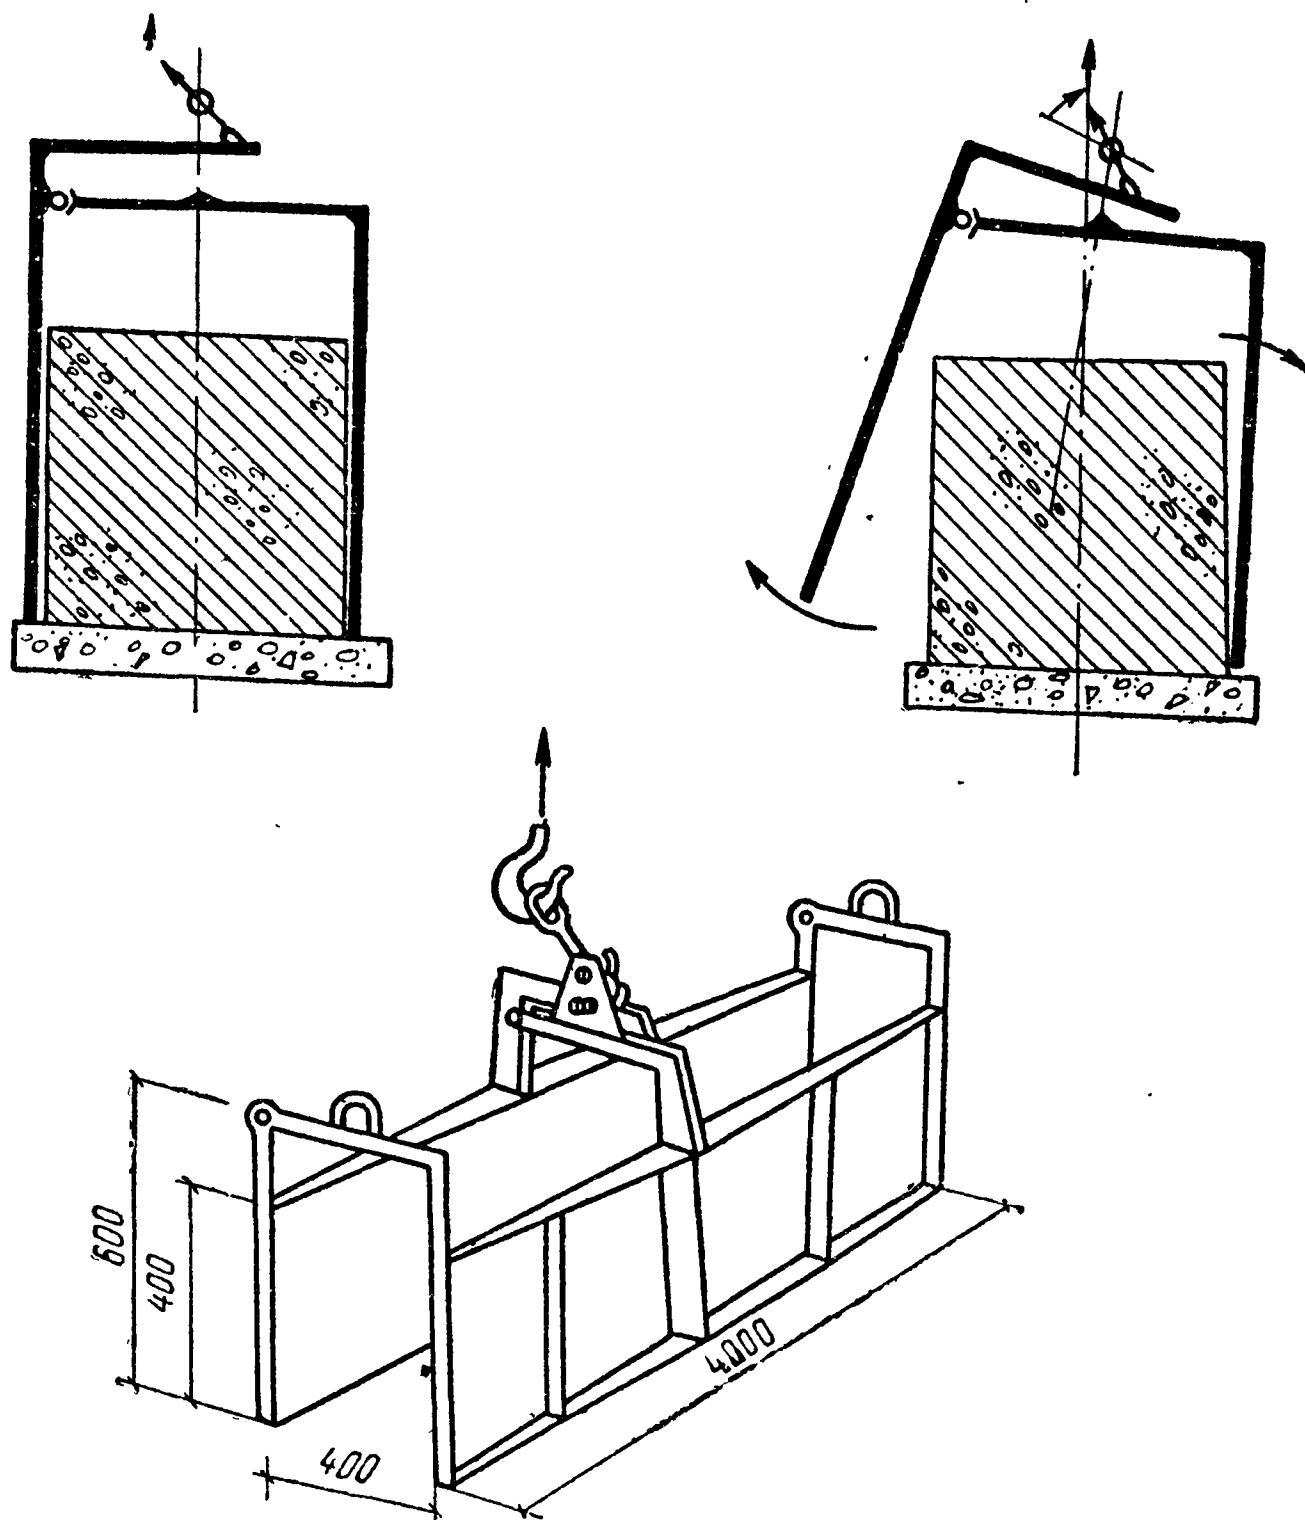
Инвентарная металлическая опалубка для бетонирования ленточных фундаментов
